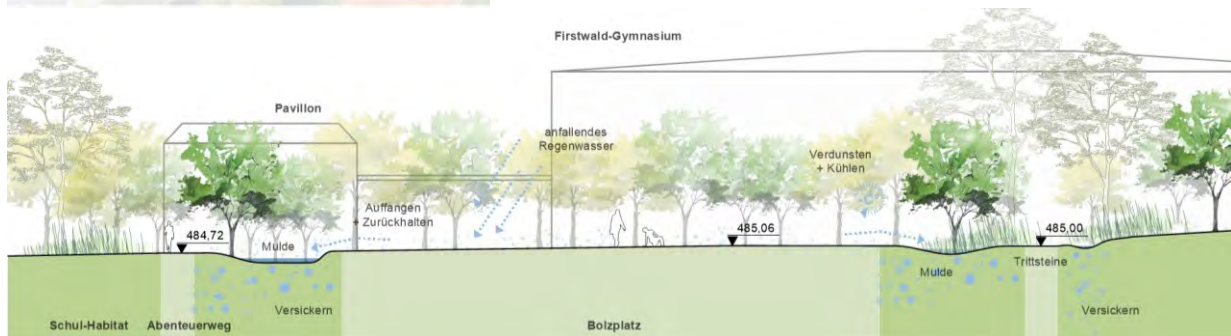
Planausschnitt Vorentwurf Sport- und Bewegungsfläche mit Bolzplatz (Anhang Plan 1.1), Schnitt (Anhang Plan 1.2) (faktorgrün, 2025)
